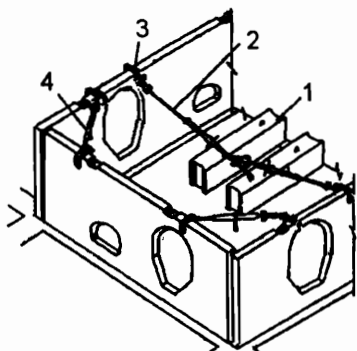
Использование фундаментных стеновых блоков в качестве якорей для временного крепления панелей: 1 – стеновые блоки; 2 – подкос телескопический; 3 – срубщина; 4 – монтажная связь
